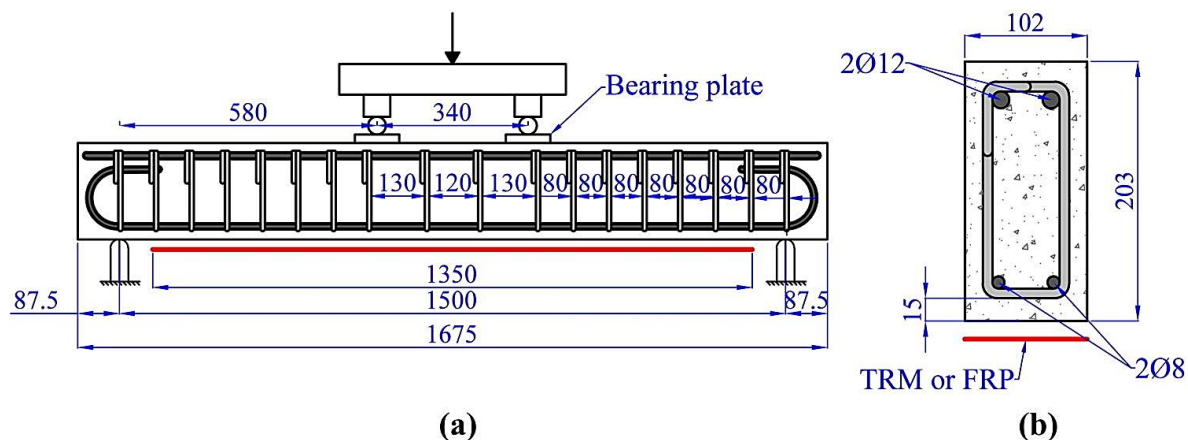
Detalles de las vigas de prueba: (a) Geometría y refuerzo de la viga; (b) sección transversal (dimensiones en mm). (Raouf & Bournas, 2017).
